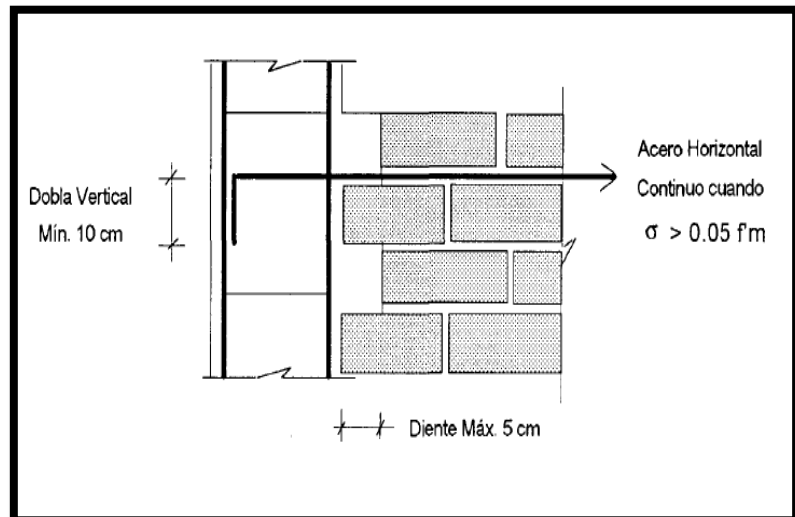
Detalle del anclaje del refuerzo horizontal continuo. (Fuente: Ángel San Bartolomé, *Construcciones de Albañilería-Comportamiento Sísmico y Diseño Estructural*”).
